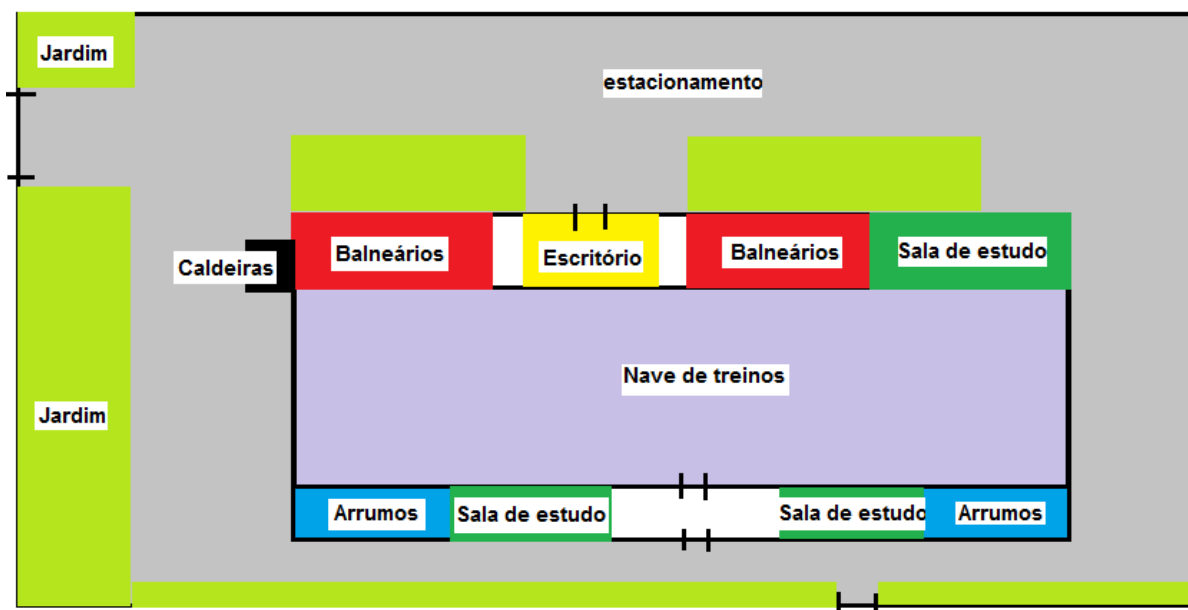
Planta do Pavilhão do Inatel da Covilhã
